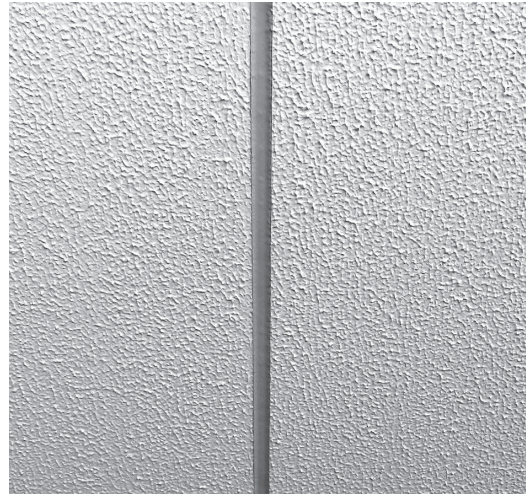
セメダイン EXCEL II の施工状況 (遠景)
